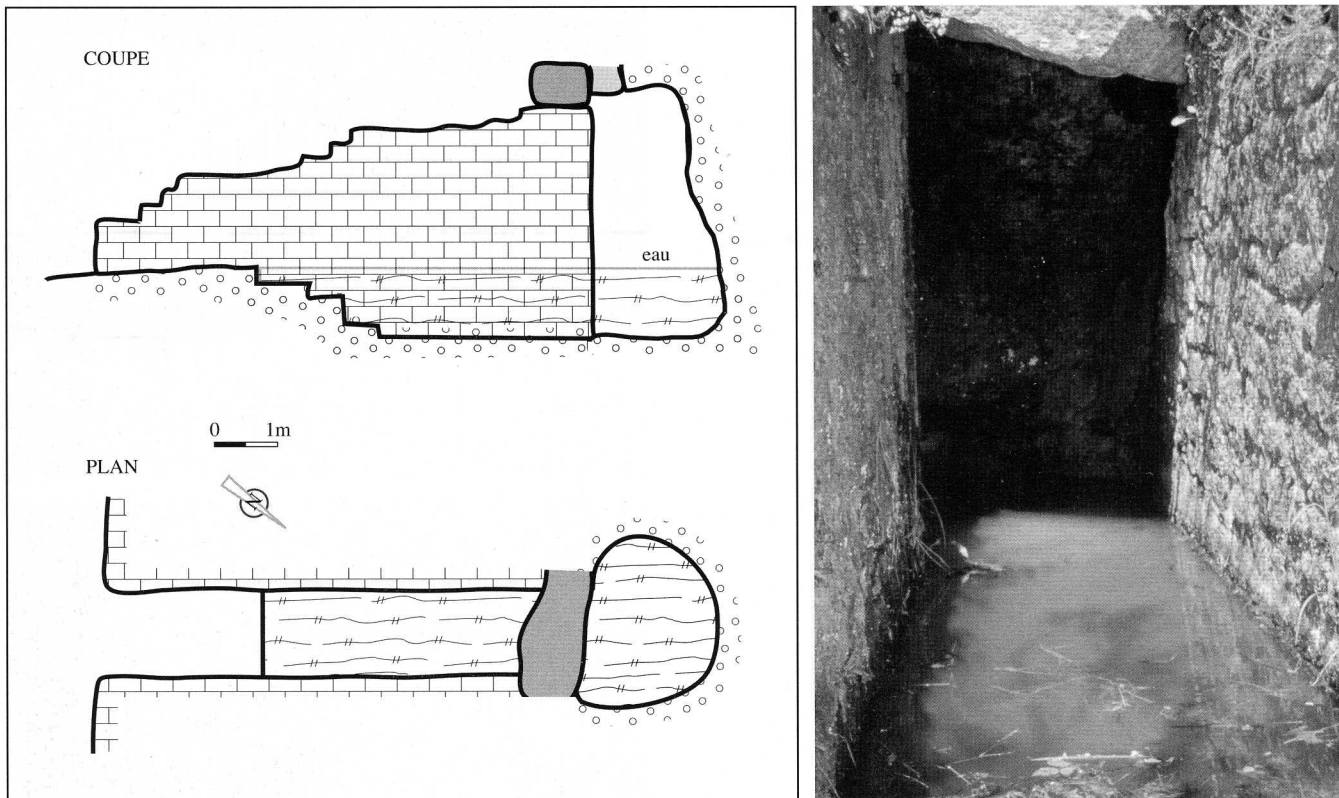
LAR00-15: a – plan et coupe; b – vue générale.
